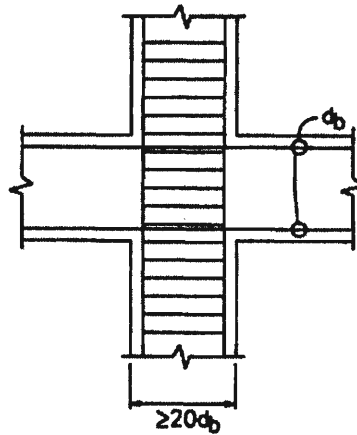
Dimensiones mínimas de los nudos para evitar el deslizamiento del refuerzo longitudinal de las vigas
